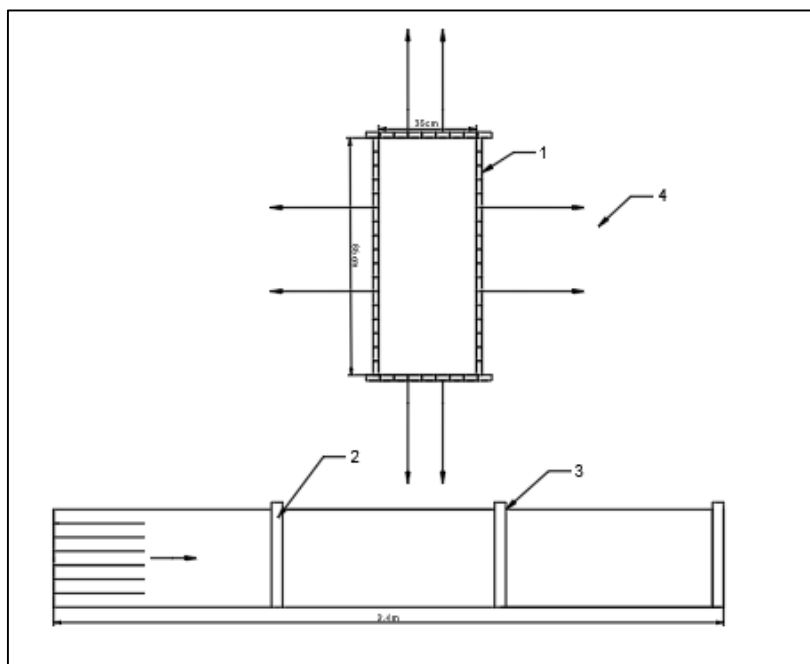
Detalle del encofrado para columnas de 35x85 cm
